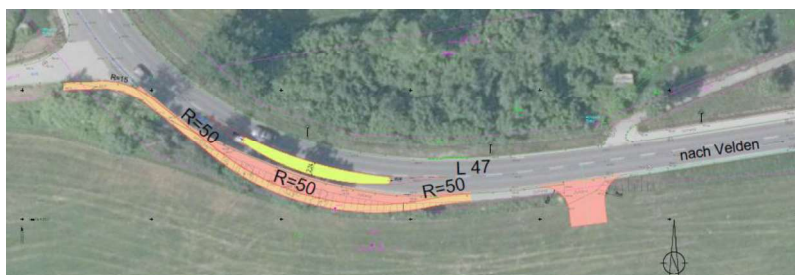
Lageplan zum Bauvorhaben (Quelle: Leder Ingenieurbüro GmbH)
